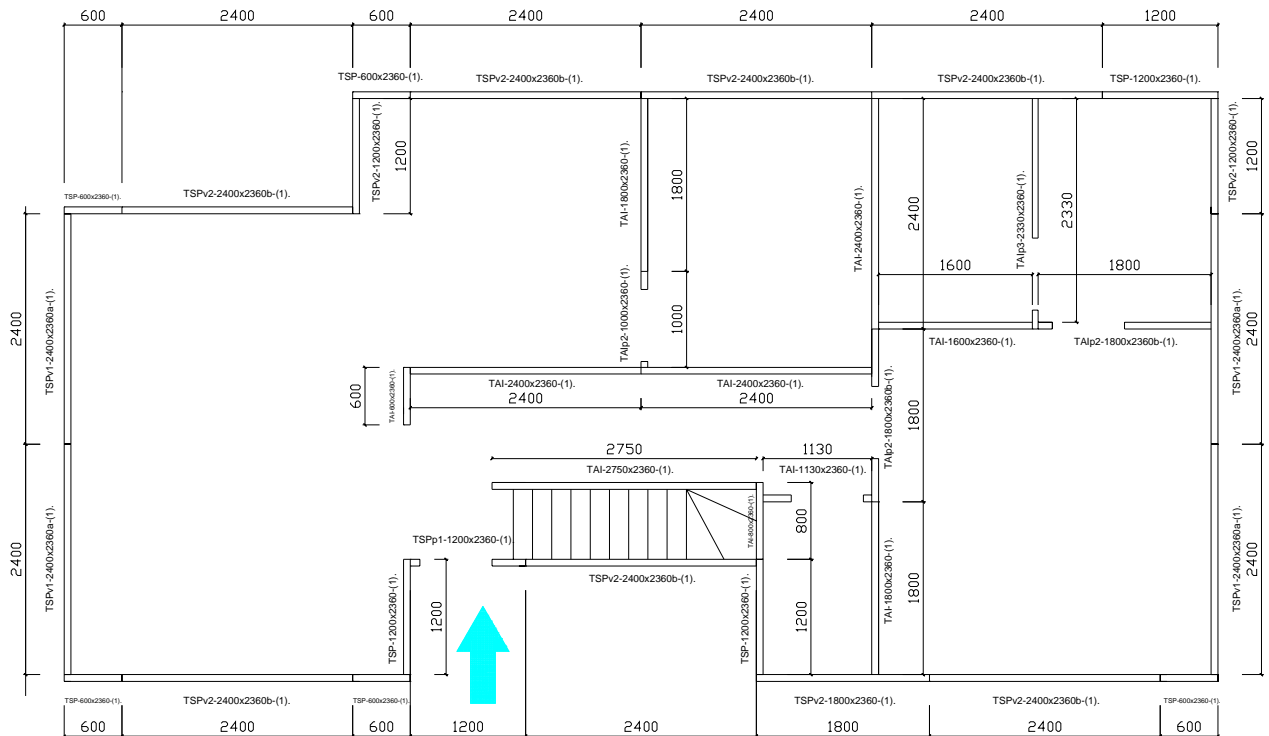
3: Plano de planta modulación de tabiques primer nivel.
